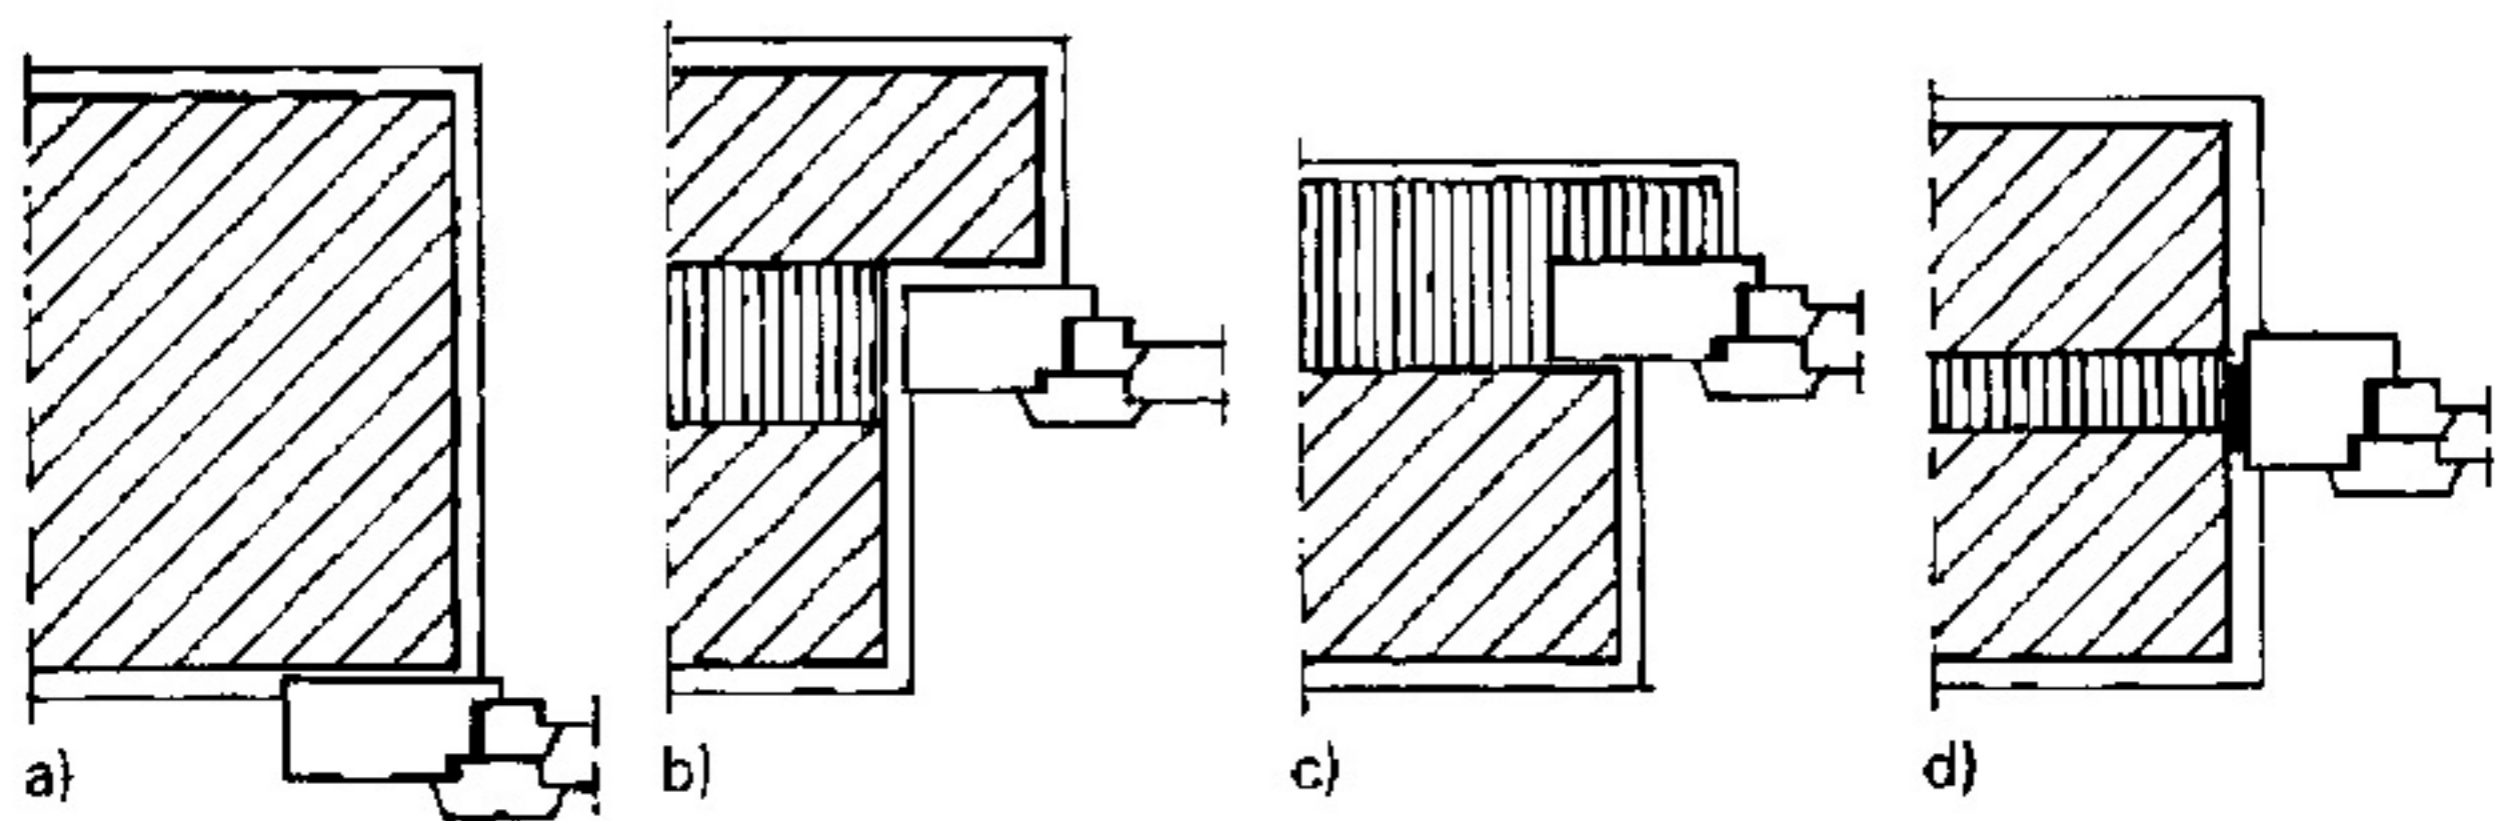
Poziția constructivă a ferestrelor în raport cu grosimea peretelui
